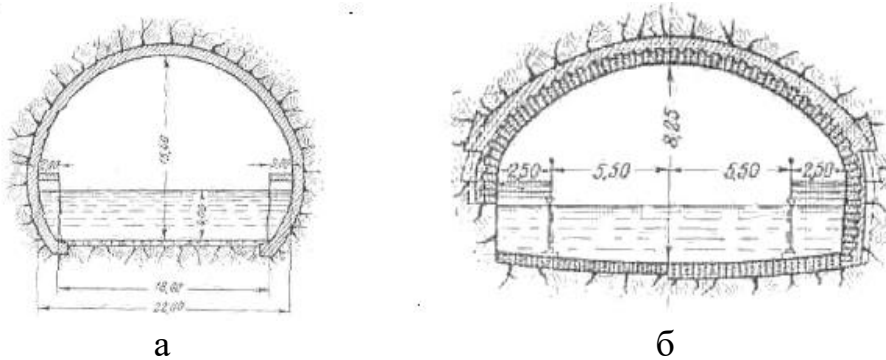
Поперечний переріз судноплавних тунелів:
